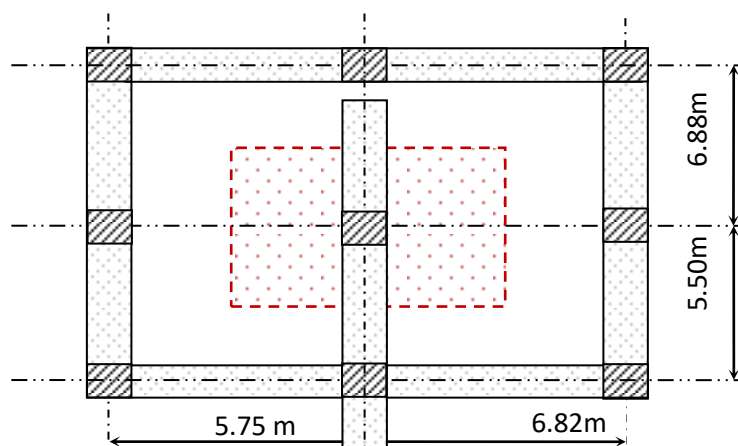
Plan de coffrage de poteau central (poteau M16)
